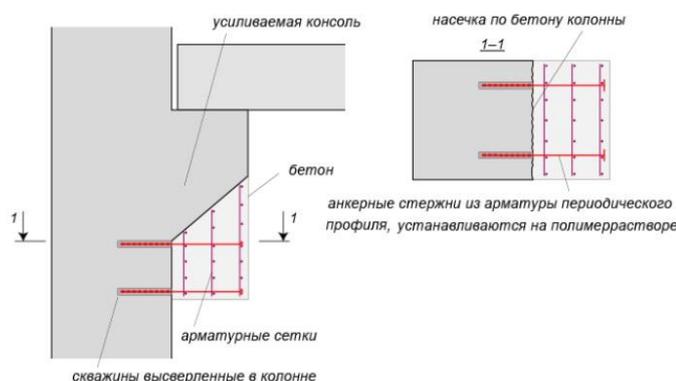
Усиление консолей железобетонным наращиванием снизу
